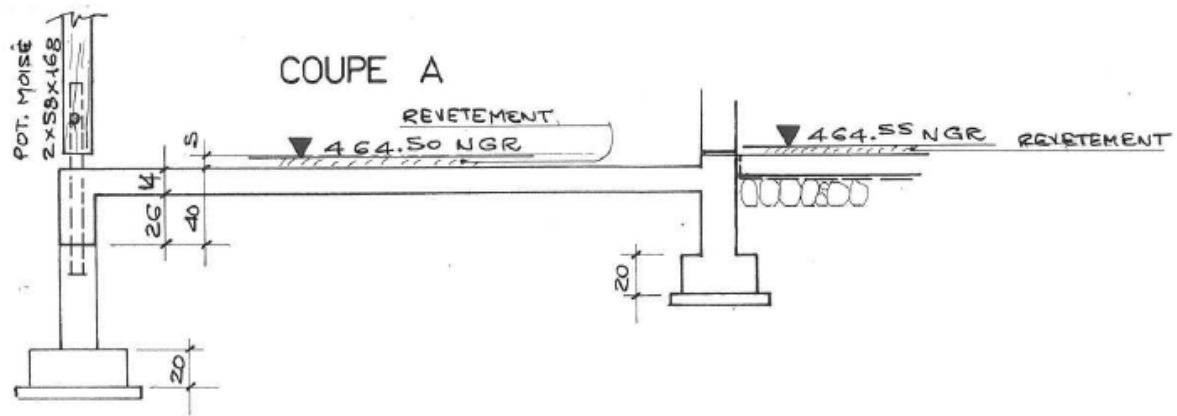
détail de "pilotis", solution pour adapter les fondations au terrain
